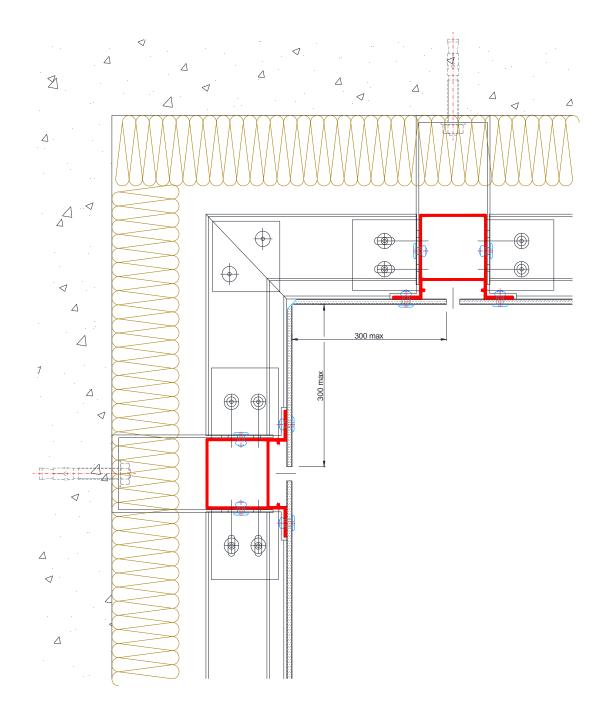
Angle rentrant – Coupe horizontale – Système riveté RV 60 4c
